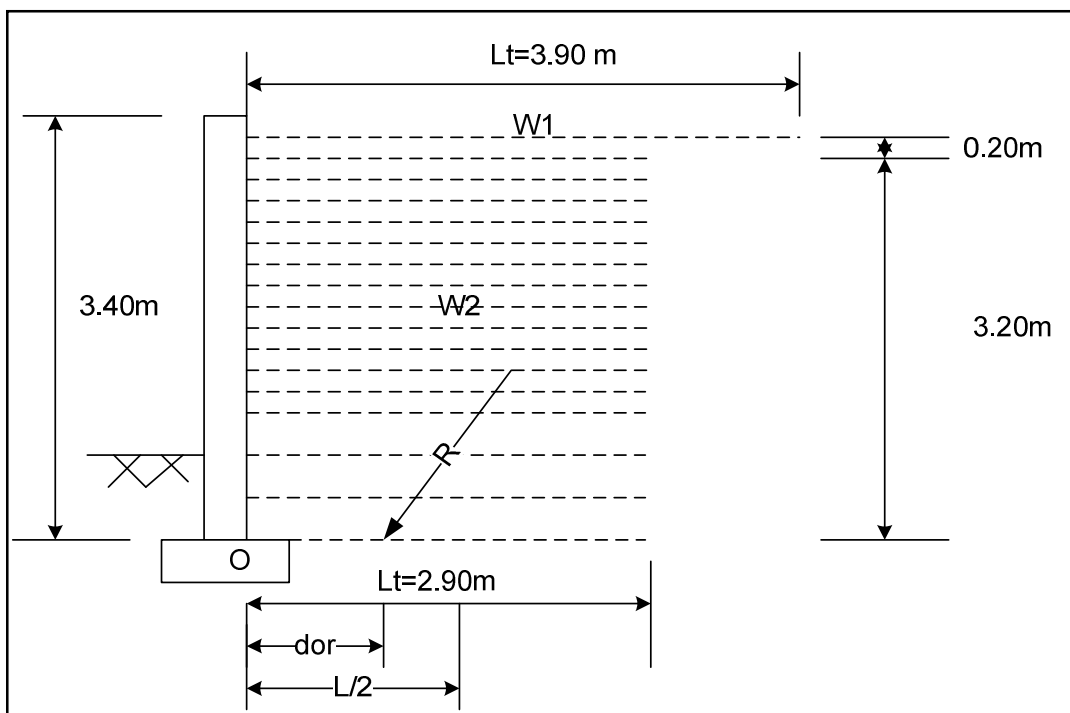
Fuerzas estabilizadoras finales muro 3 m
